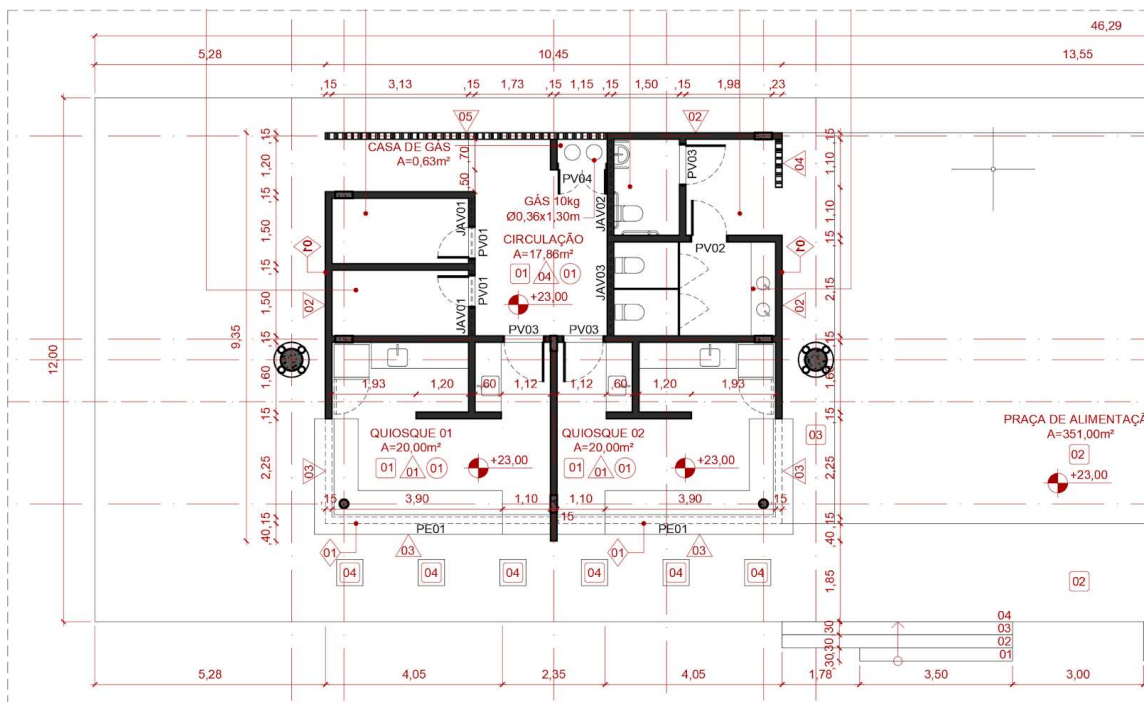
Executivo Quiosques da Praça do Barco: Planta Baixa - SketchUp
